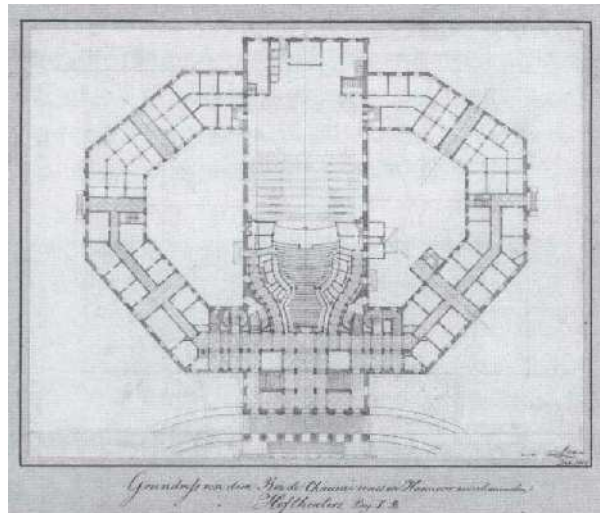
Grundrissentwurf des Erdgeschosses (Projekt I B) von G.L.F.Laves, 1843 (StA-H, LN 54).
